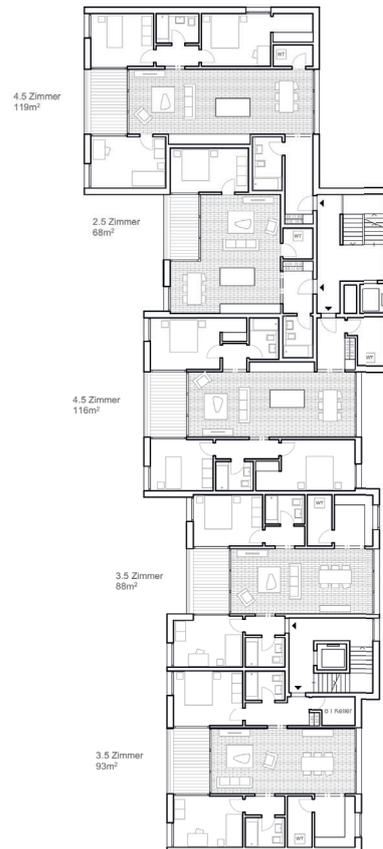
Regelgeschoss mit typischen Wohnungsgrundrissen
